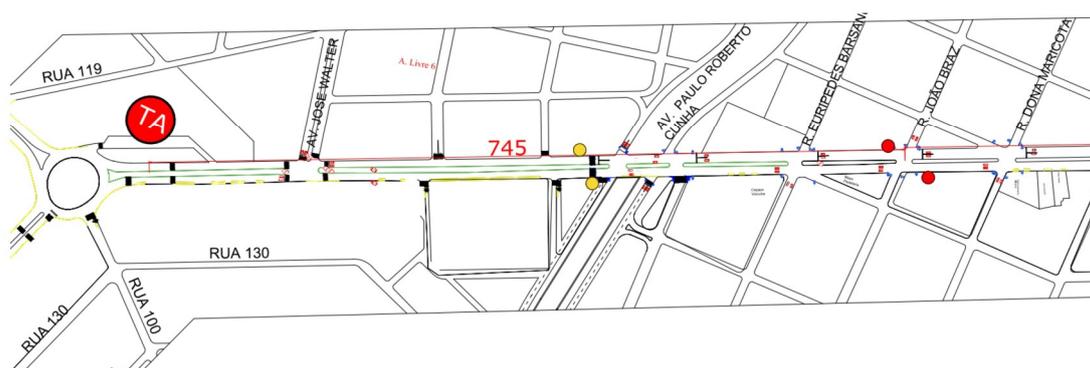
Locais onde serão instalados os miniterminais na Avenida Presidente Vargas (trecho 1).
